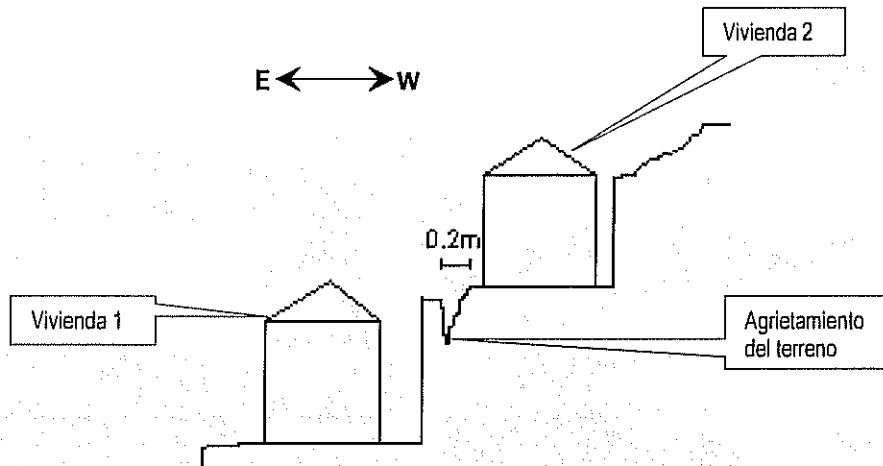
Esquema de la ubicación de las viviendas evaluadas sobre la ladera
